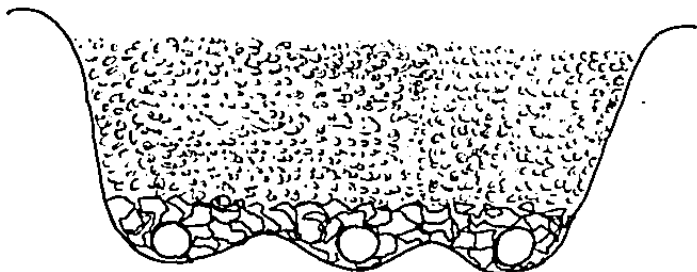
CORTE LONGITUDINAL DE LA LAMINA DE ASBESTO PARA
